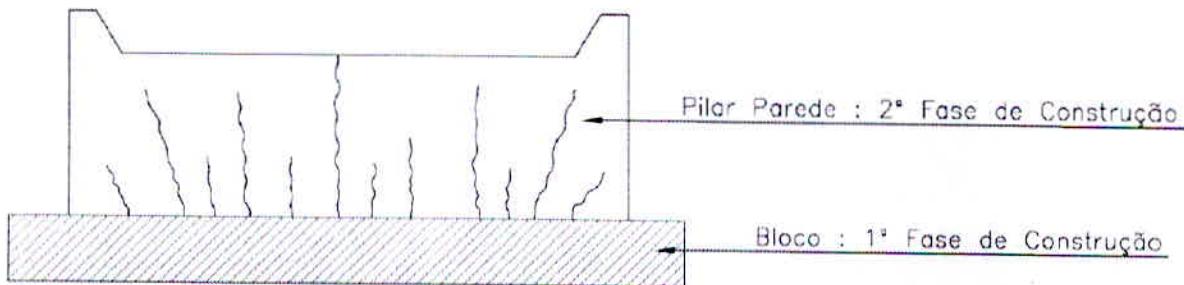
Fissuras típicas de retração plástica do concreto
